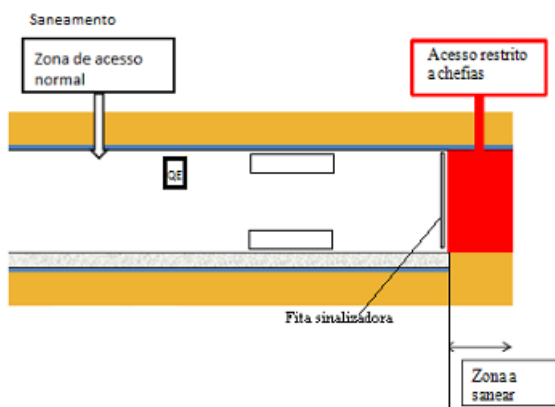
Zona de restrição em frentes de escavação (fonte: autores)
